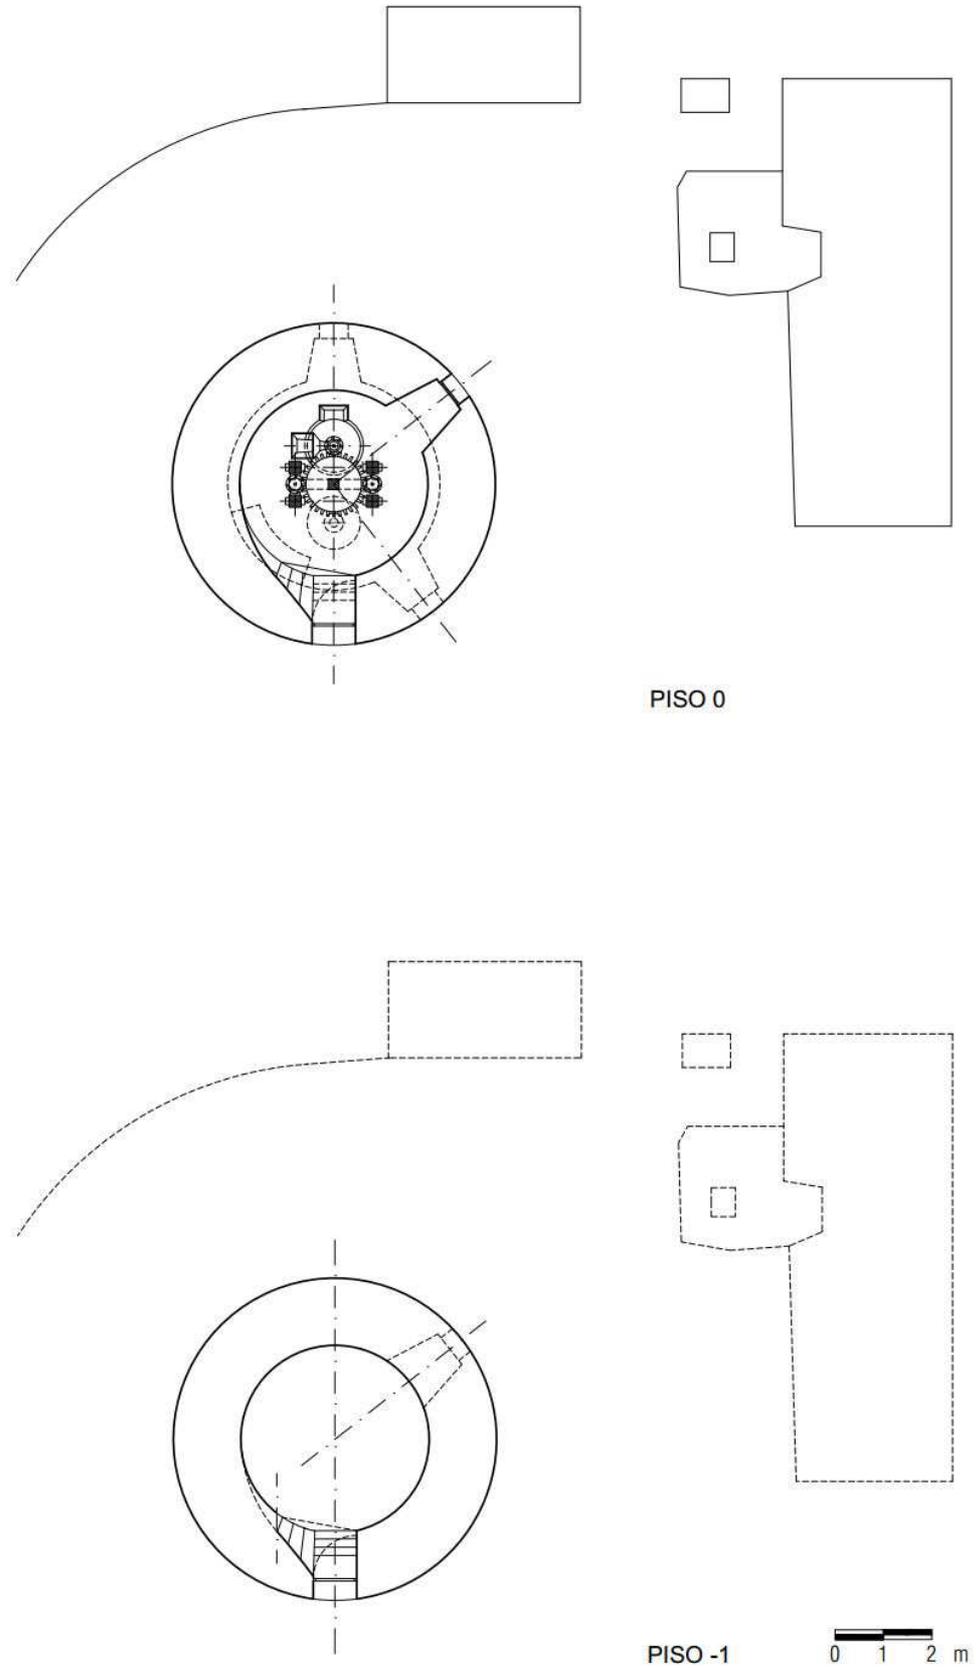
Plantas dos pisos -1 e 0. (Paulo Ferreira, 2013)
